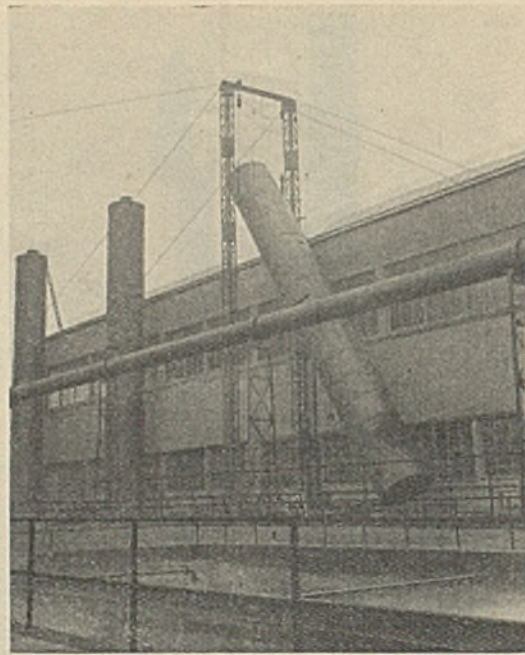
Drei Behälter, davon zwei fertig aufgestellt. Der dritte wird hochgewunden.
